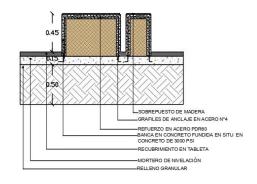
Detalle arquitectonico ejercitador pierna doble.
